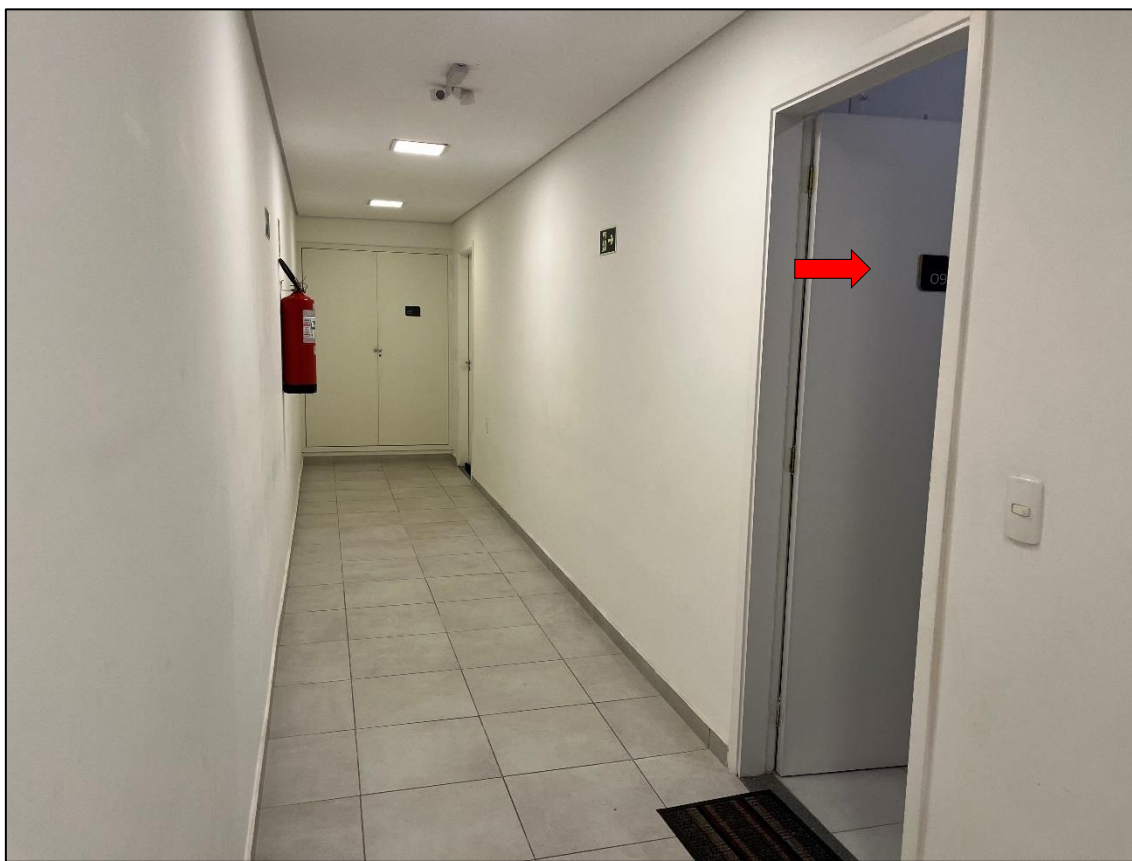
Vista do pavimento térreo da Torre I onde está localizado o apartamento nº9 avaliando.
